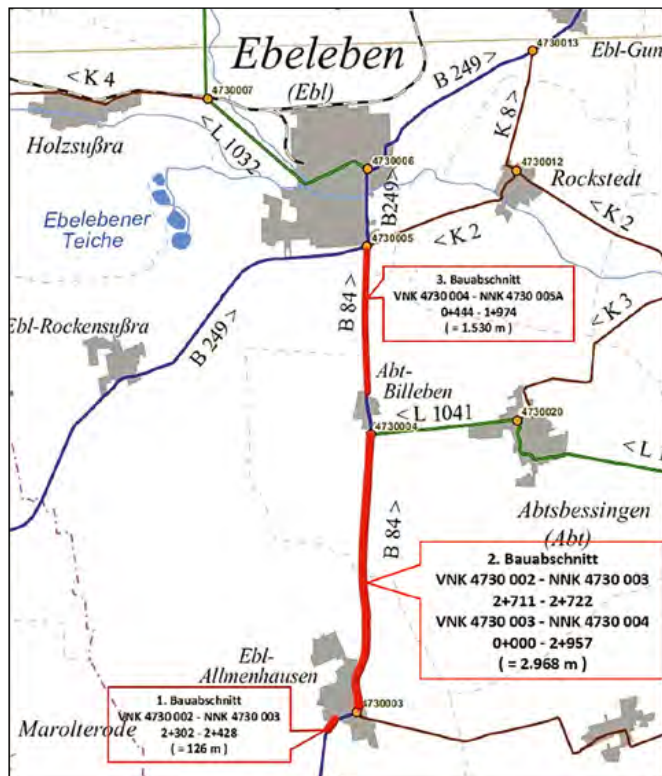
Übersichtslageplan der Baumaßnahme B 84 Allmenhausen-Billeben
